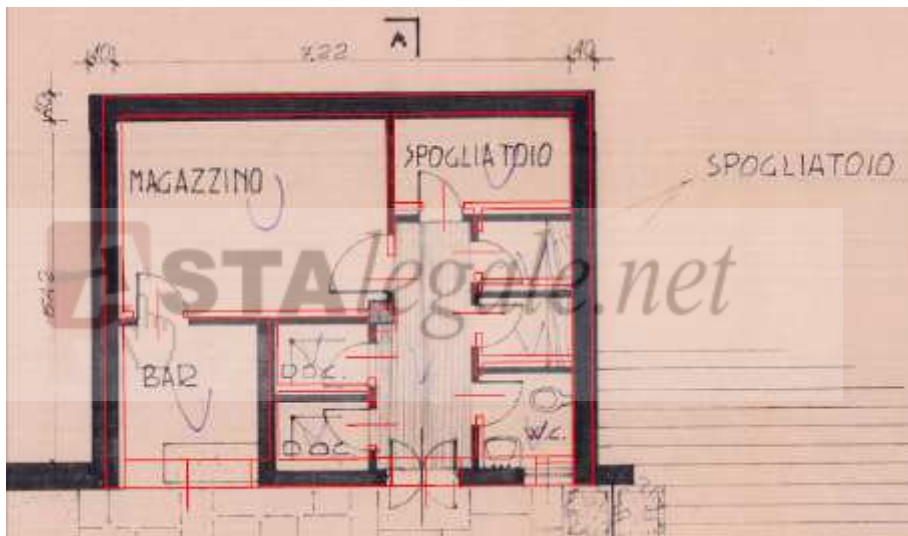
Comparazione stato attuale – stato approvato – vani accessori piscina.
